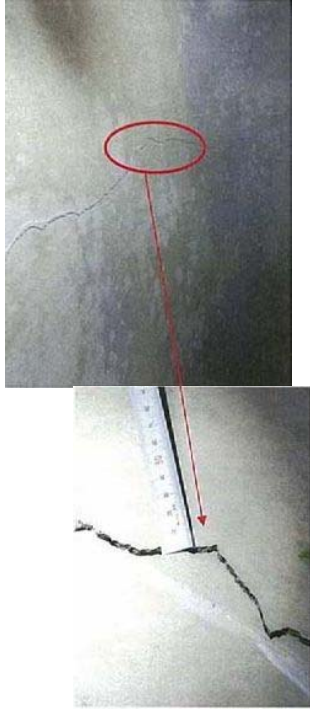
覆工スパンの中間付近に発生したひび割れの例 2)
